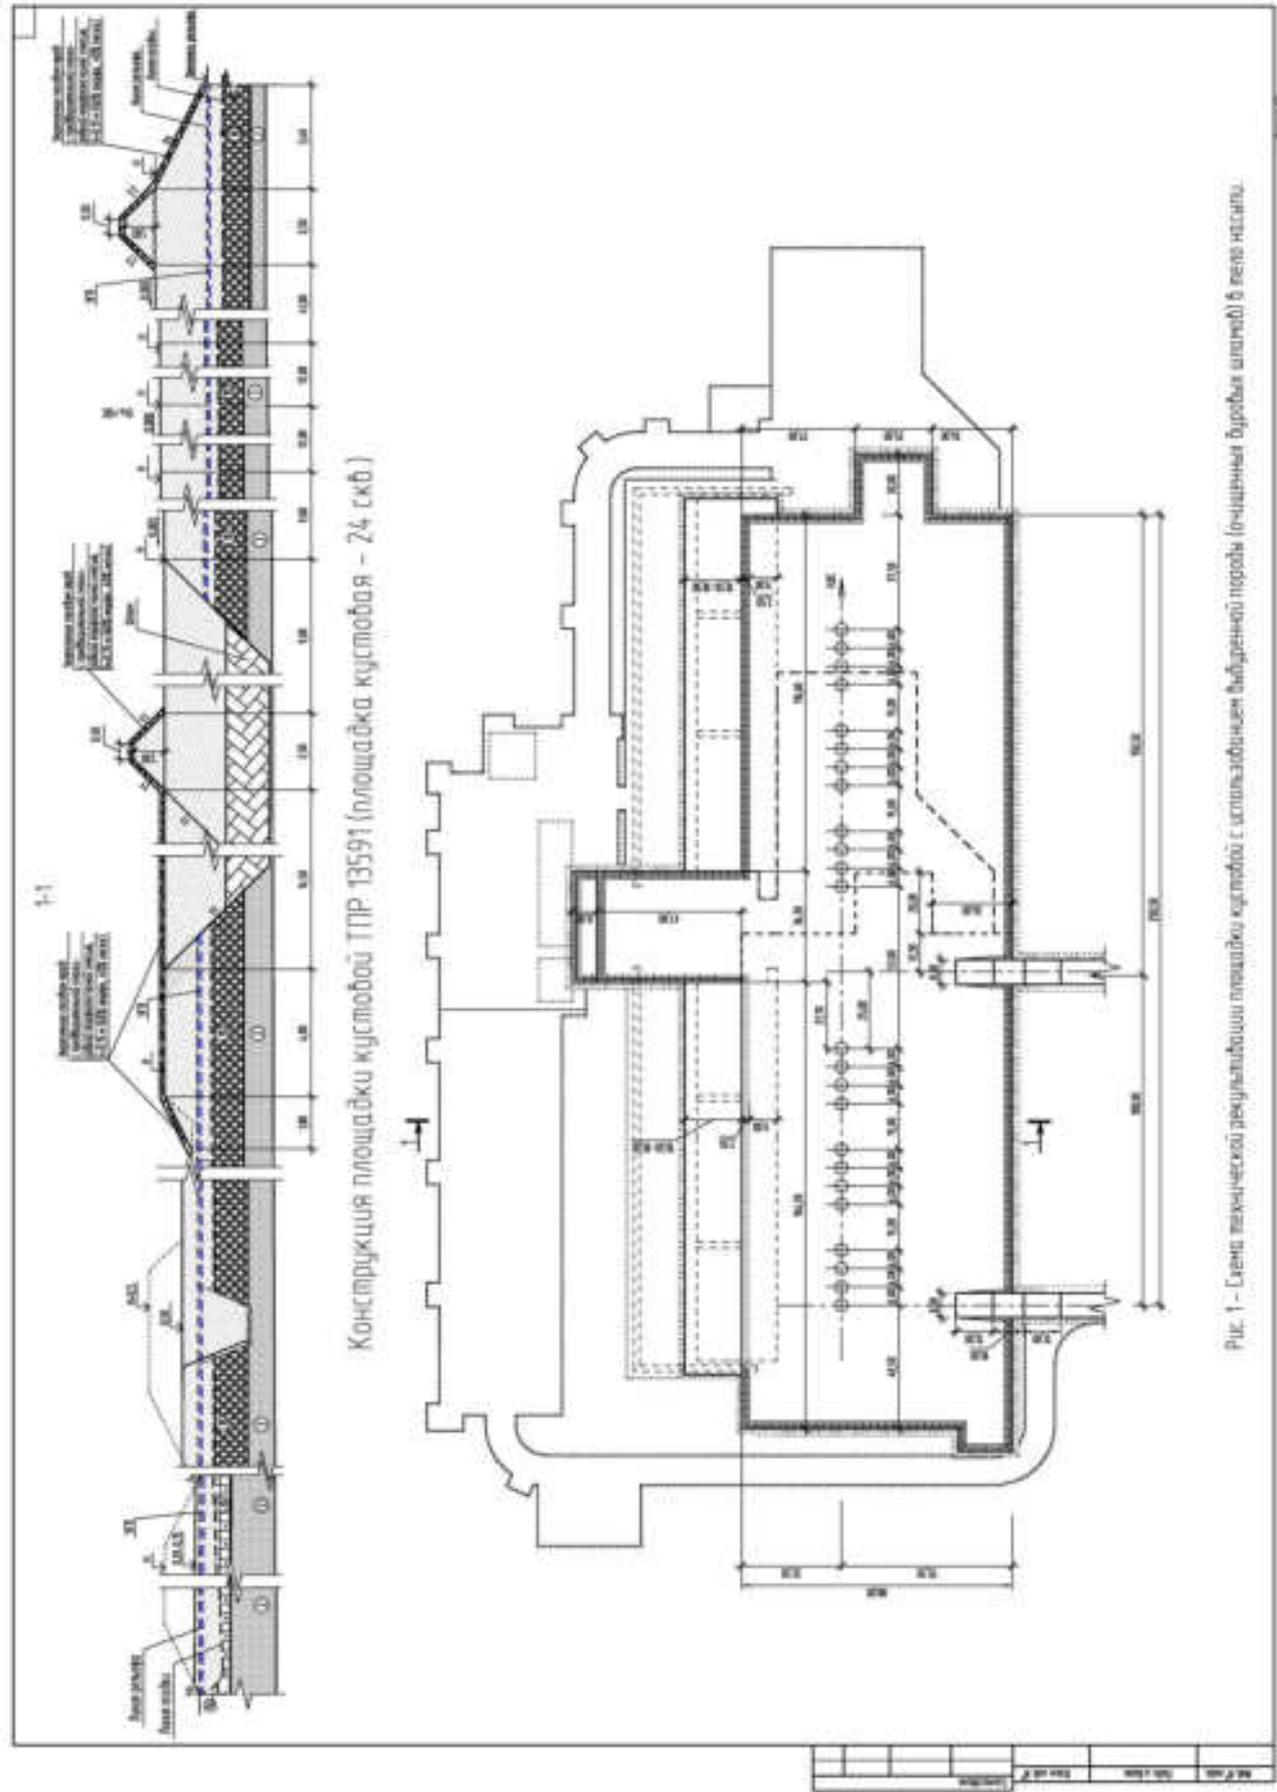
Схема планической реконструкции площадки кустовой с использованием буровой породы (использована буровая шлама) в тело насоса.
